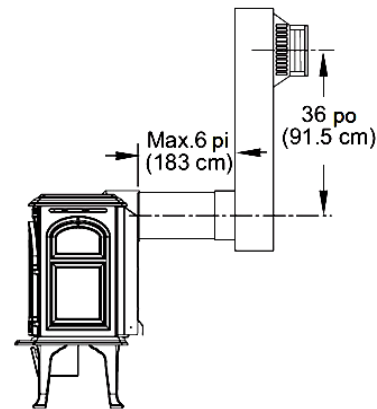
Conduit d'évacuation horizontal maximum avec terminaison tuba (*Snorkel*) de 36 po.
